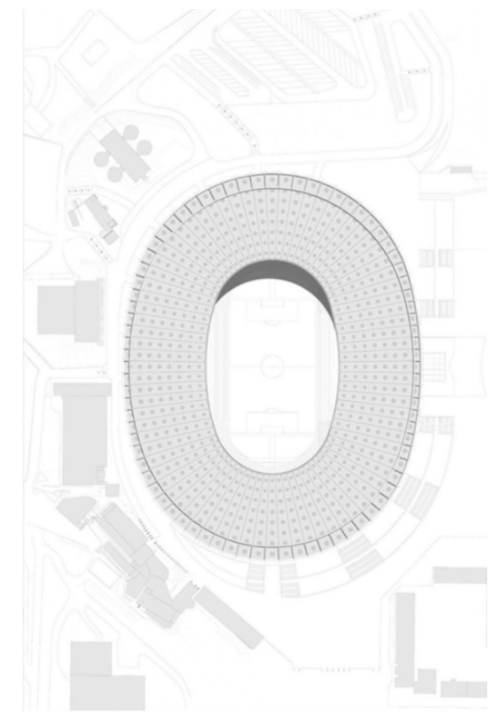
Planta de cubierta del estadio olímpico de Kiev
